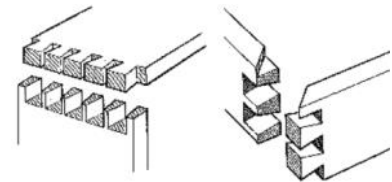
Conexión estructuras de madera tipo cola de milano.
